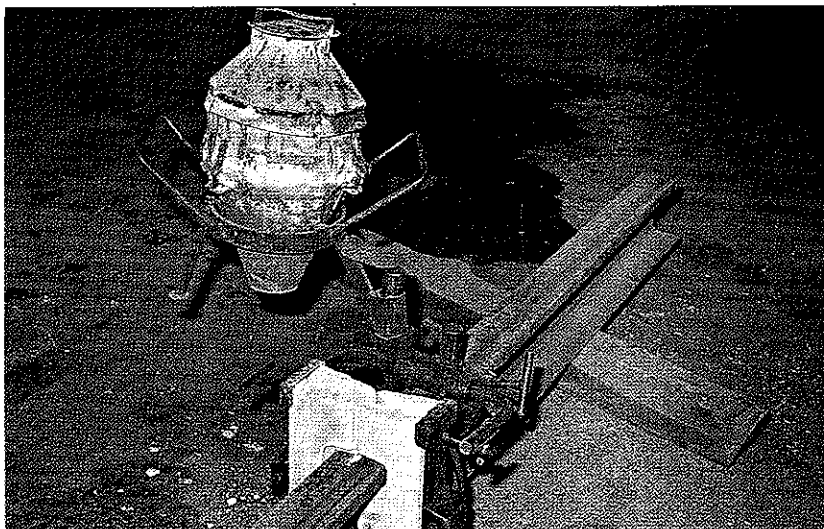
Soudure des rails par le procédé Aluminothermique
